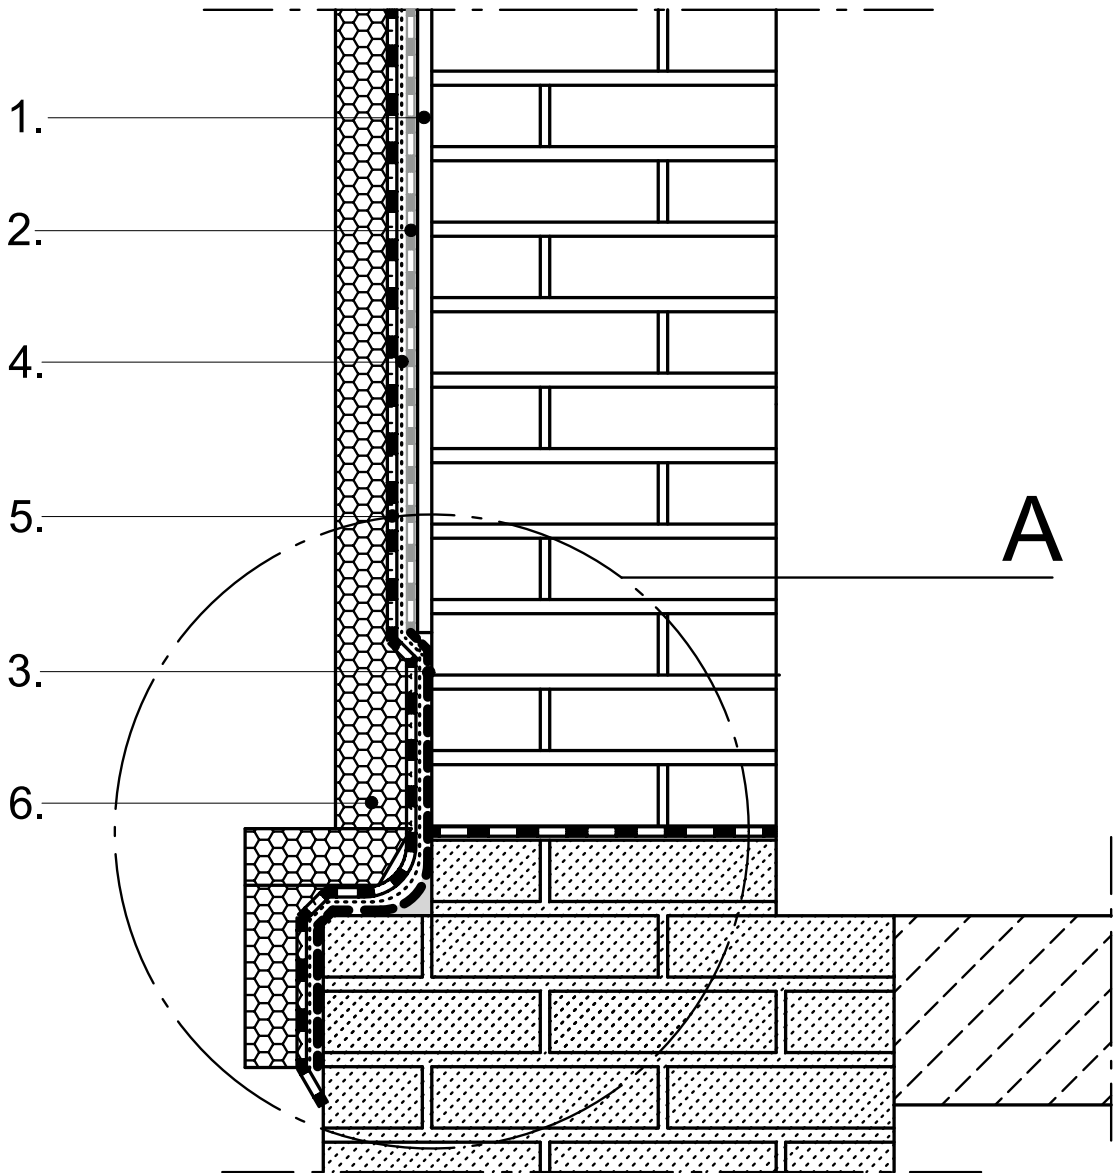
Anschluss einer Außenabdichtung an eine Bodenflächenabdichtung bei W1-E
